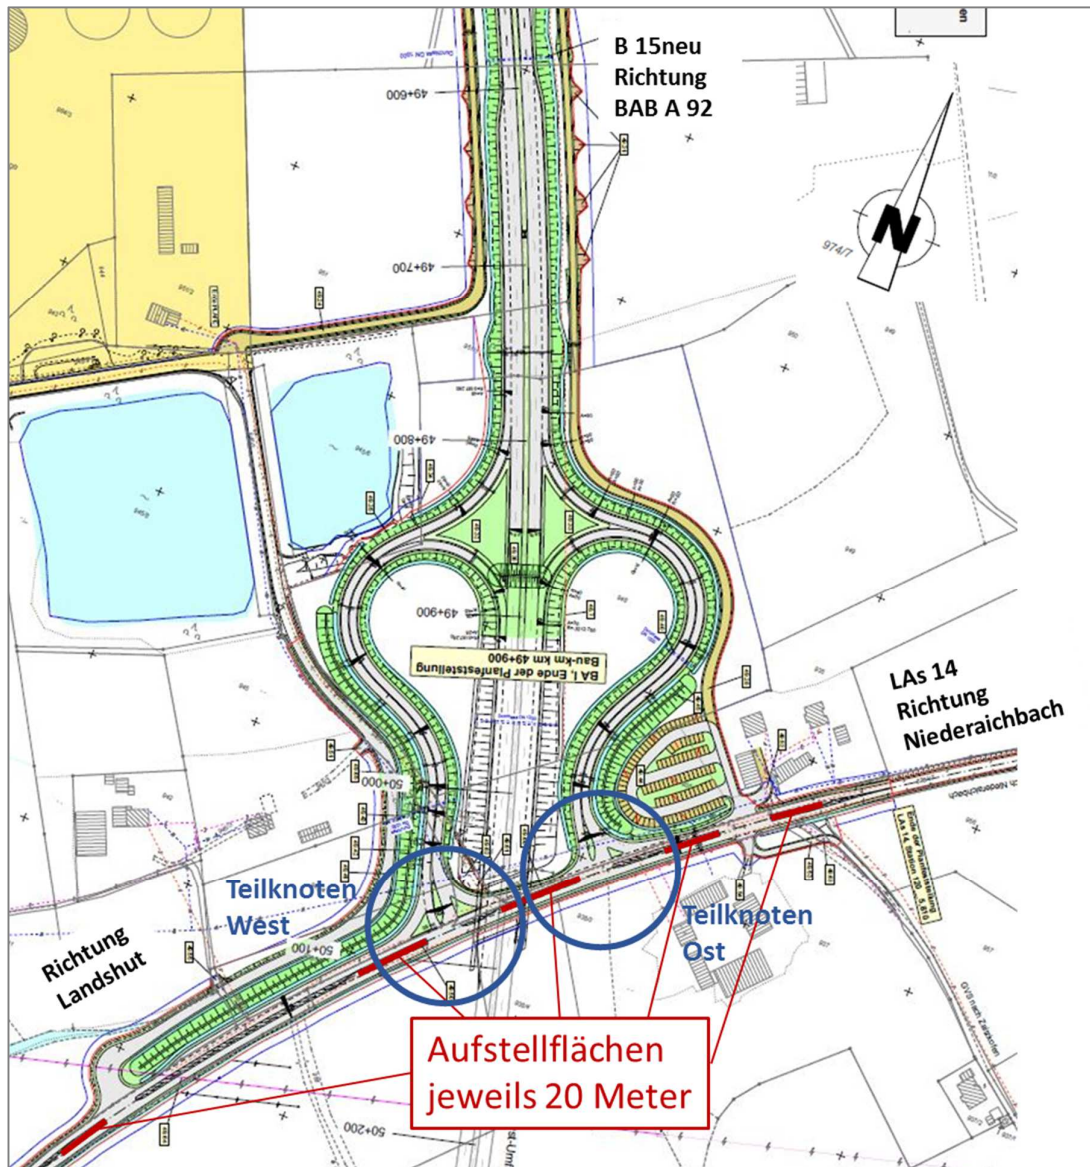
Lageplan K1 – KP Dirnau (Stand 14.03.2018)
